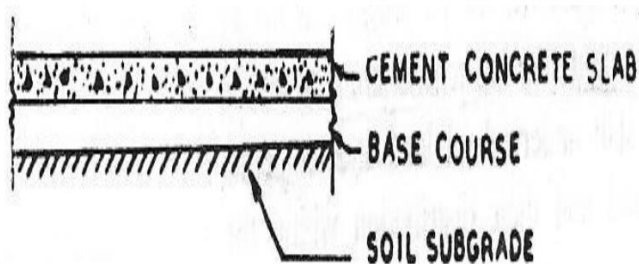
Sección transversal del pavimento rígido, por Mohod y Kadam, 2016, p. 86
